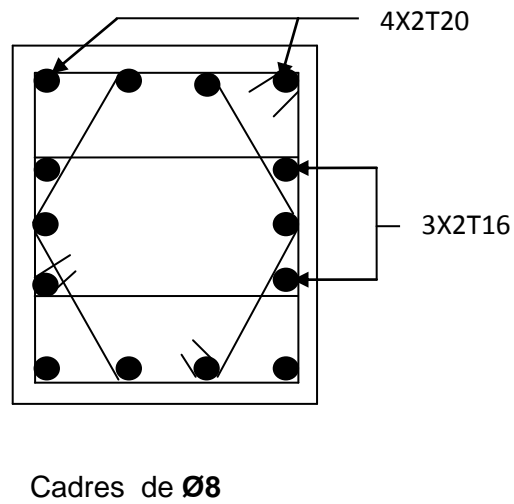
schéma de ferrailage des Poteaux (70x65)
